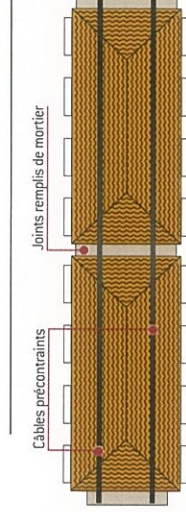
Solidarisation de 2 bâtiments par prélage de câbles précontraints (vue en plan)
